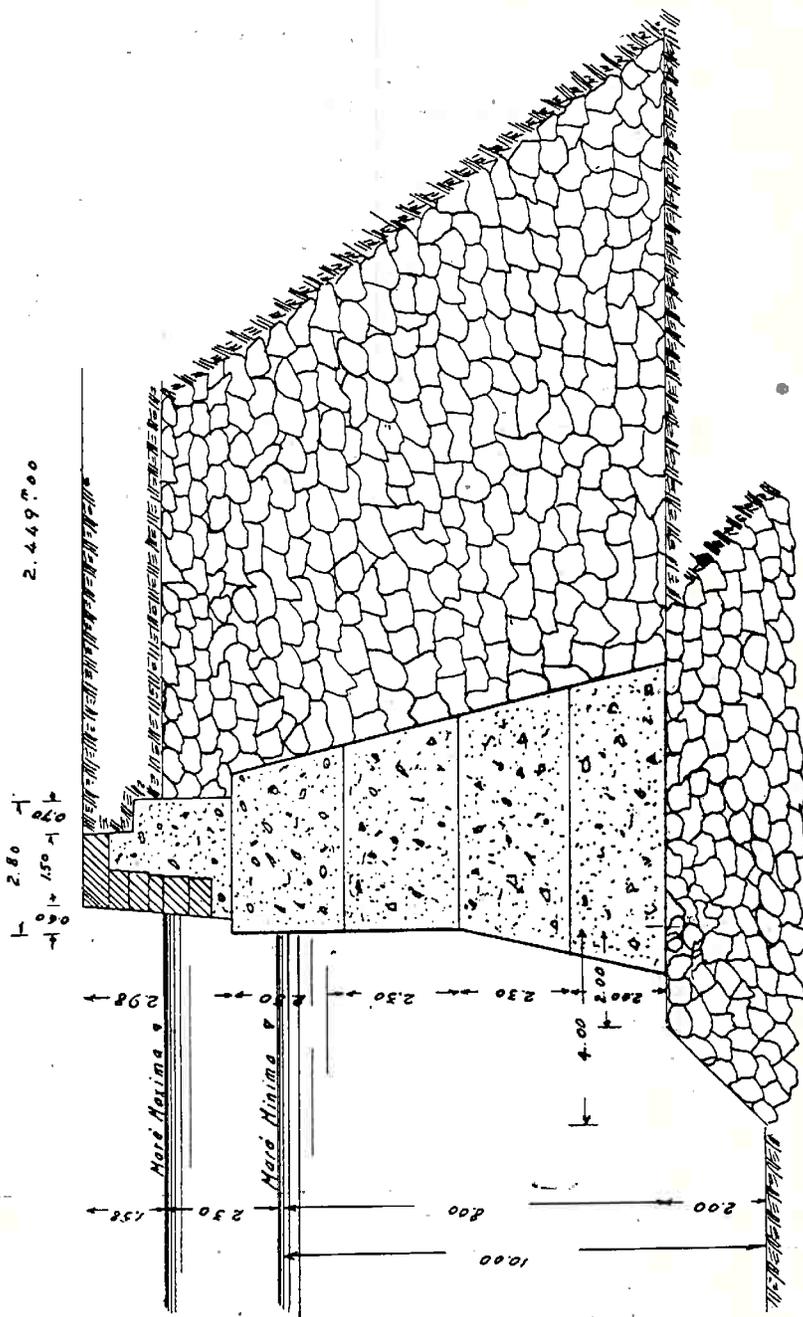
Segundo tipo de muralha do porto de Santos.
